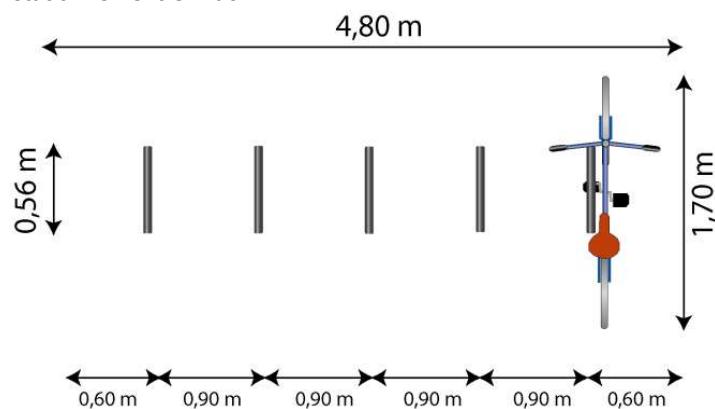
Exemple de stationnement le long d'un mur (rangement perpendiculaire). Possibilité de réduire l'espacement entre les arceaux à 0,7m
